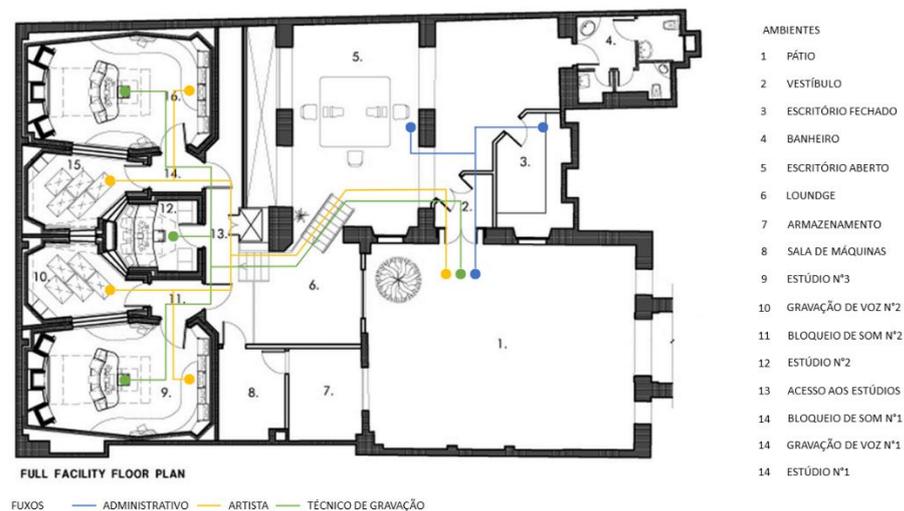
Fluxo – Estúdio Mach2, Planta Completa das Instalações
